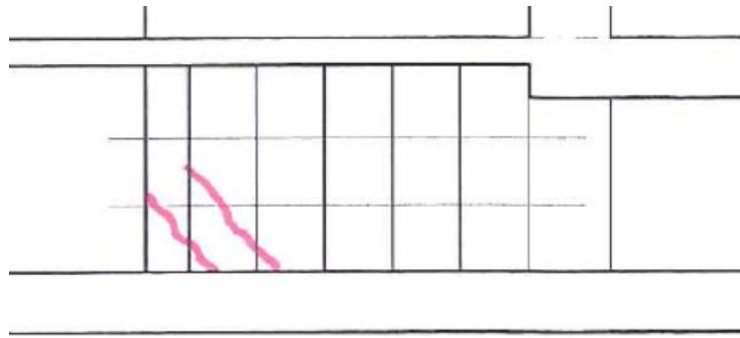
Levantamiento de fisuras en muro interior de 30 cm de espesor a fecha de 10/02/2016.
